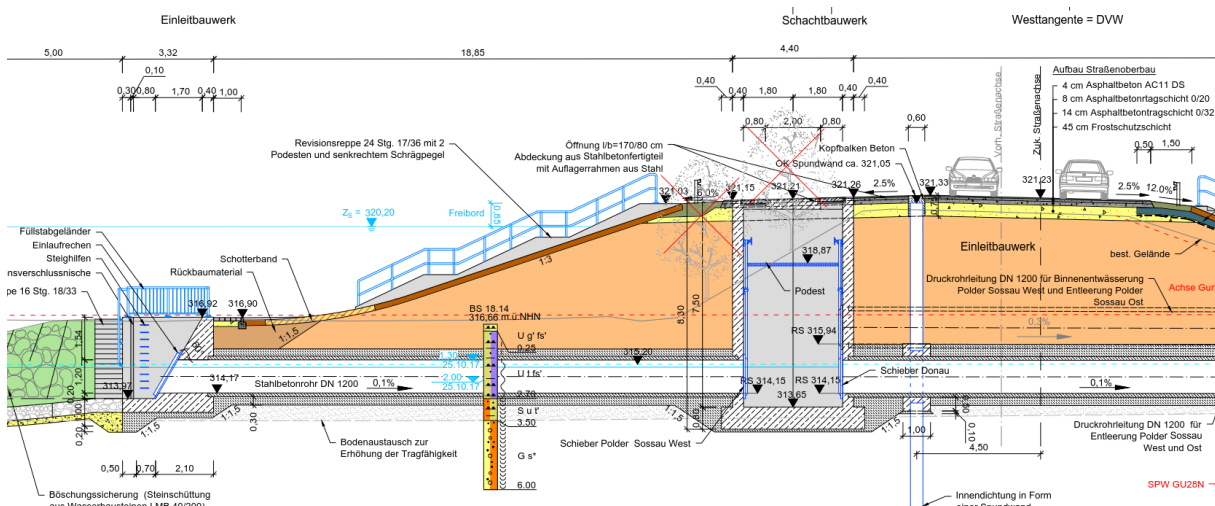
Entleerungskanal Polder Sossau, Längsschnitt Einlauf- und Schachtbauwerk (aus Plan 04-12-05, Blatt 1/2)
